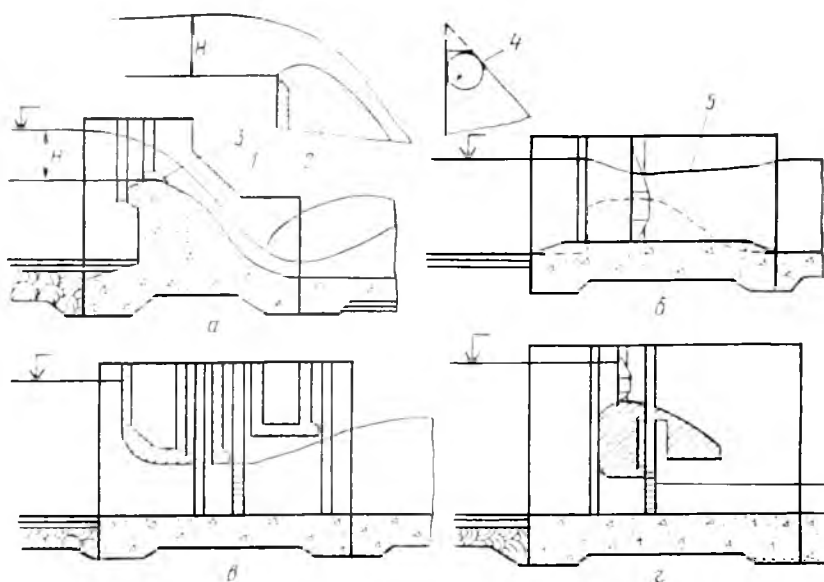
Основные типы бетонных плотин на не скальных основаниях:
